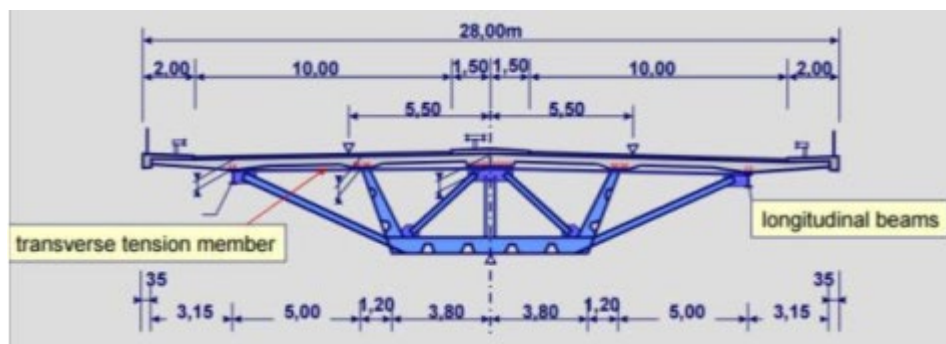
Переріз балки коробчастого типу з подовженими консолями залізобетонної плити.
